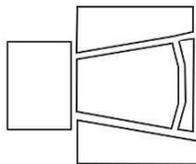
Adição e Subtração: a porção do centro cultural onde se encontra o teatro é formada por um quadrado definido (caixa de palco) e outro que se divide em 4 partes (platéia e espaços auxiliares). (Fonte: Autora, 2006)
